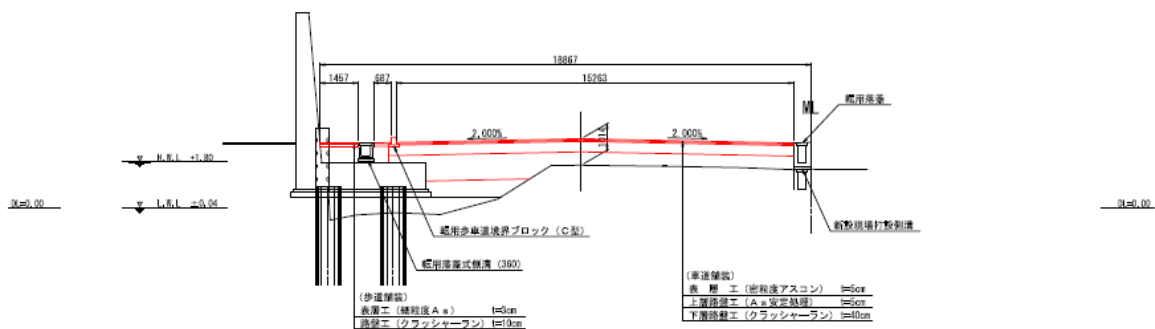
37 No. 1 朝日大川路線 (A) 標準横断面図 ANO. 32 (復旧後)
